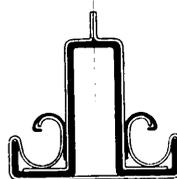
η-förmige Glaslagerabdichtung (Glaslagerabdichtung).
